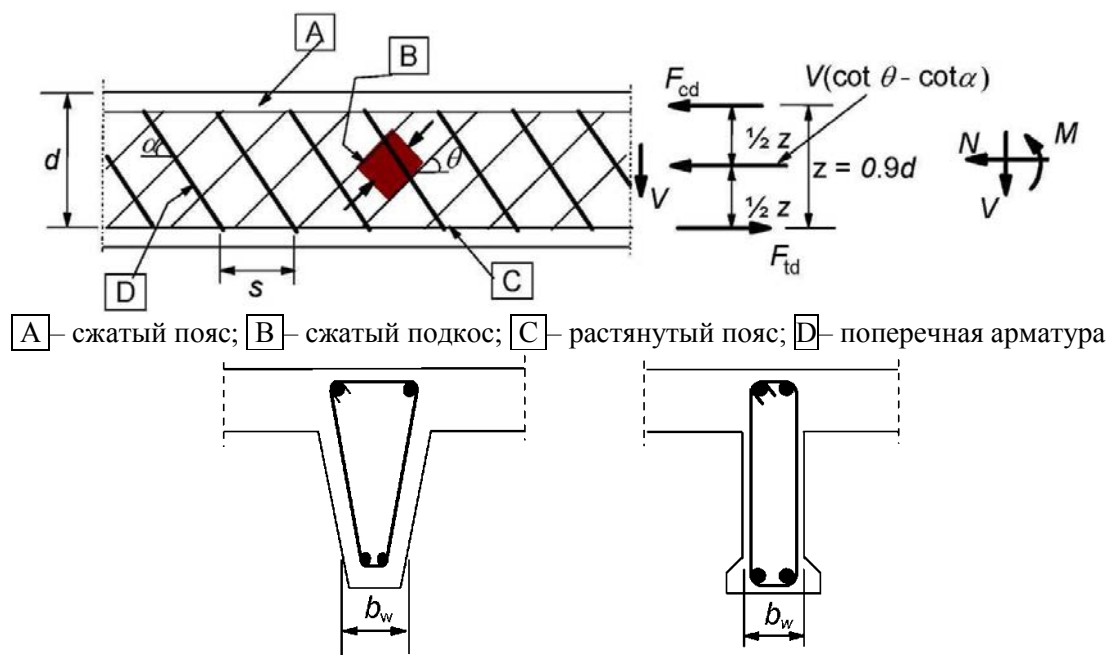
Ферменная модель и обозначения для элементов с поперечной арматурой
